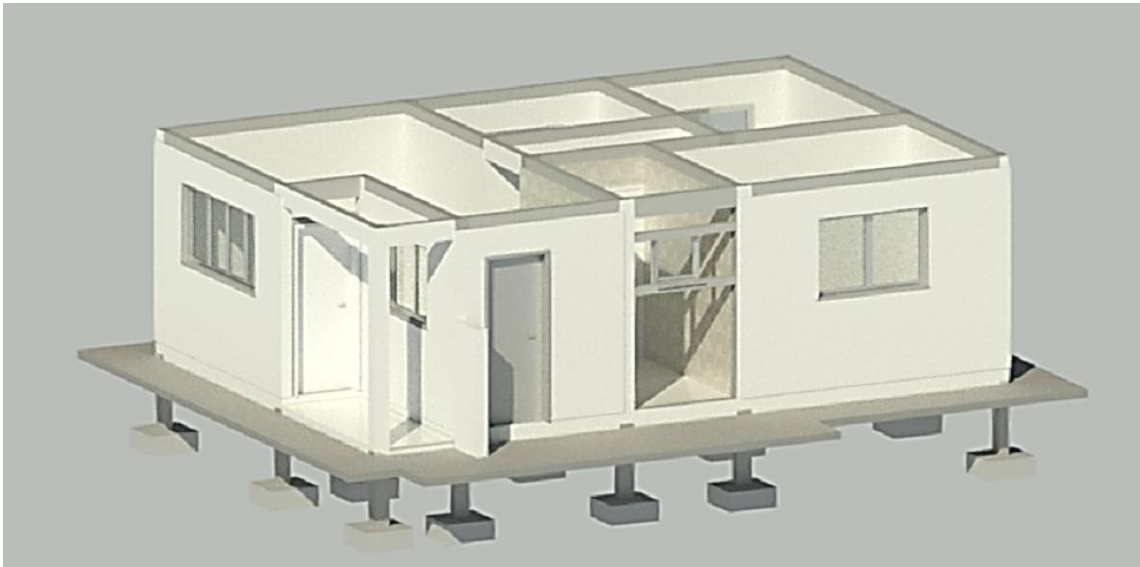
Esquematização sistema estrutural com as vergas e contravergas tipologia I
